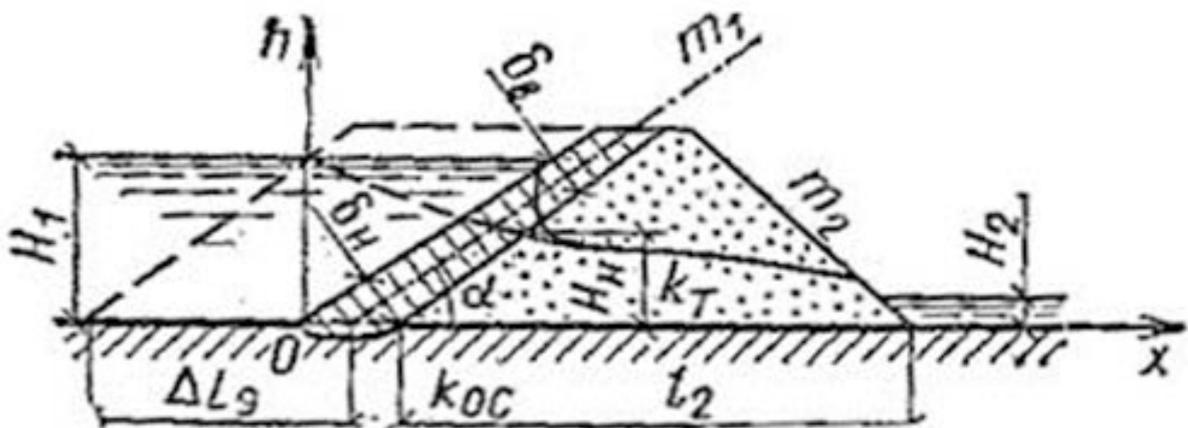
Схема к расчету фильтрации через земляную плотину с экраном
